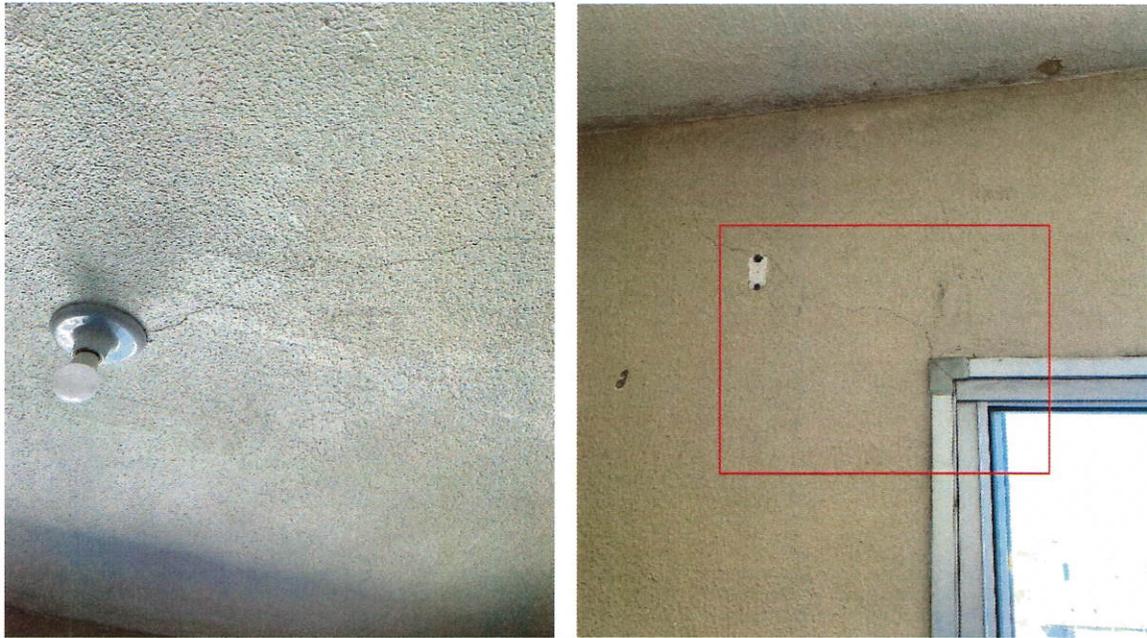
Fissuras em alvenaria e fundo de lajes
